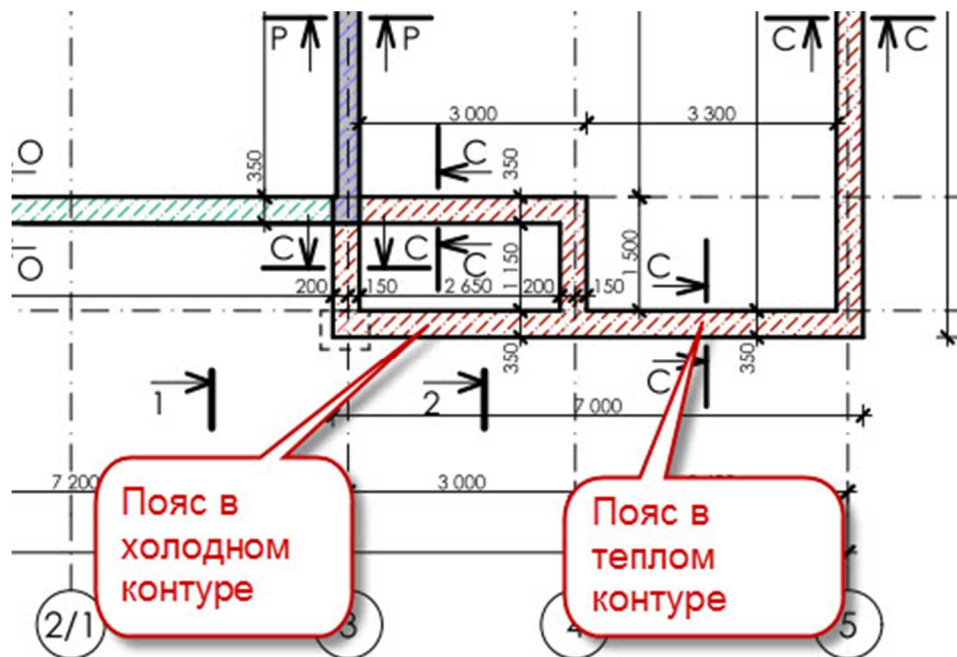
Фрагмент плана монолитного пояса (лист 43).
